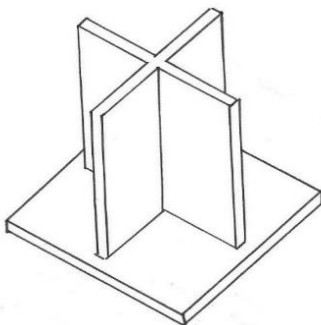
Pilar utilizado no apoio da estrutura exterior
